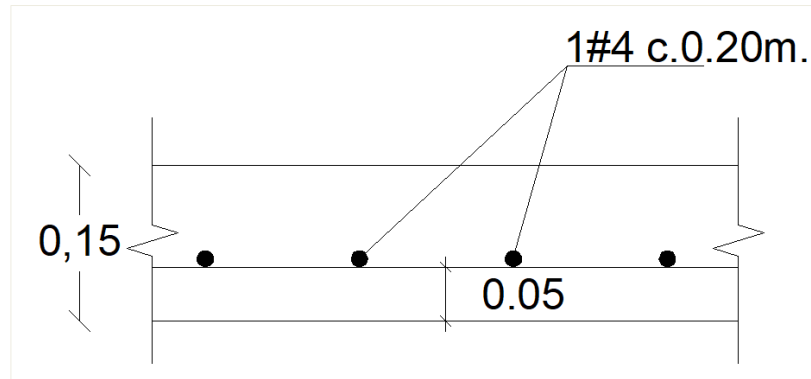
Detalle de losa de tapa tanque de almacenamiento.
